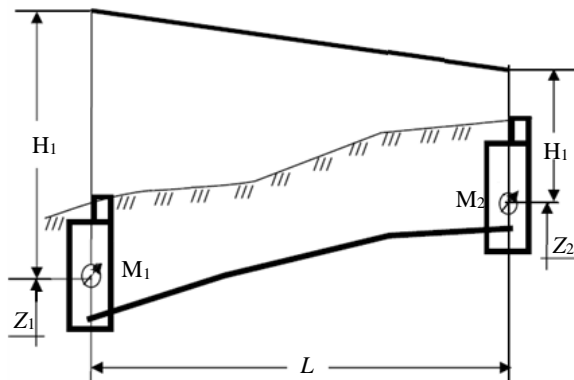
Схема определения сопротивления водовода [30]
